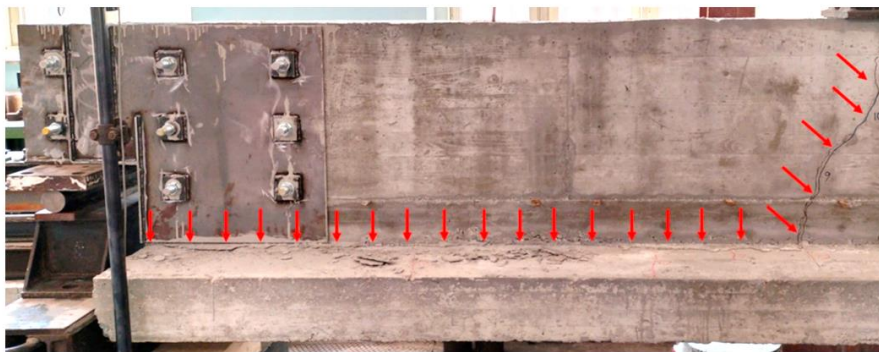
(d) Meccanismo di collasso. Trave B nello schema statico 1 [2]
